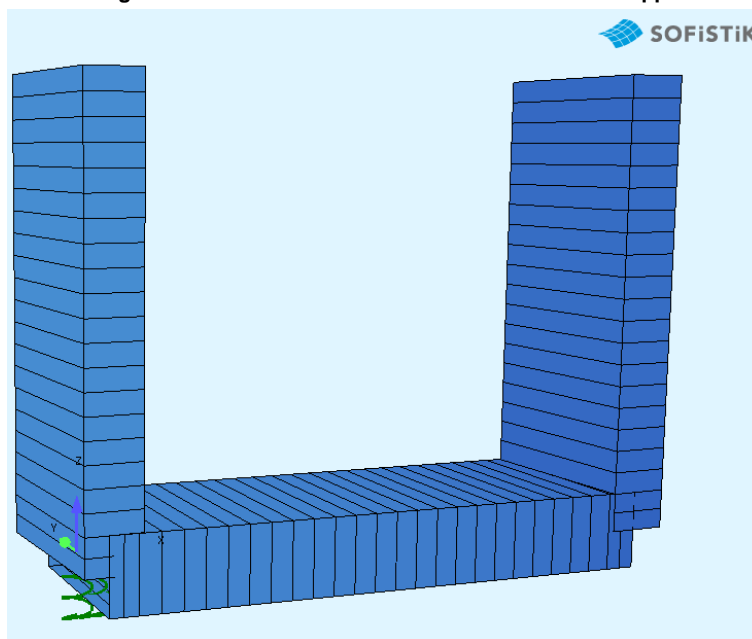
Sezione trasversale muro ad U –vista 3D
